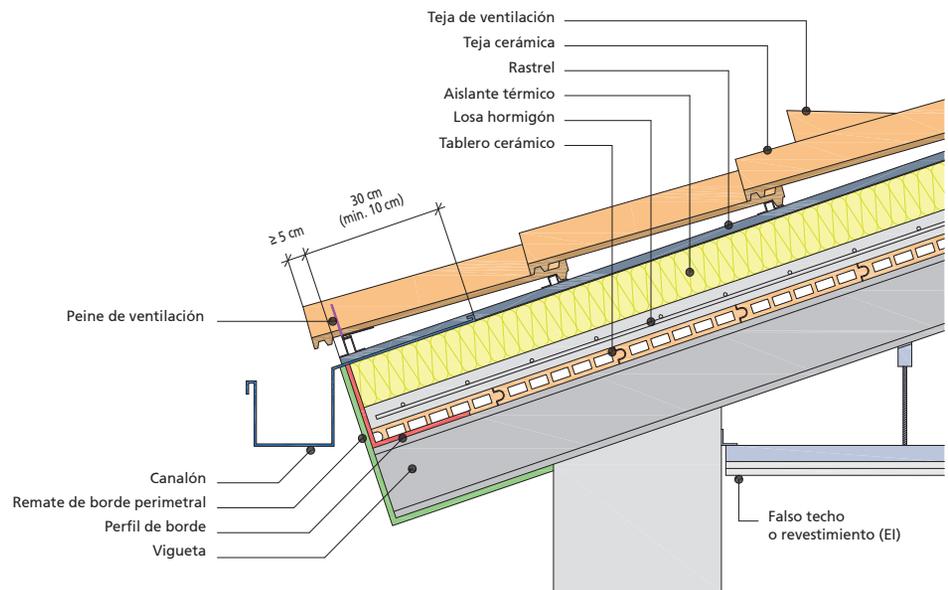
Cubierta inclinada de tablero cerámico sobre viguetas autoportantes
